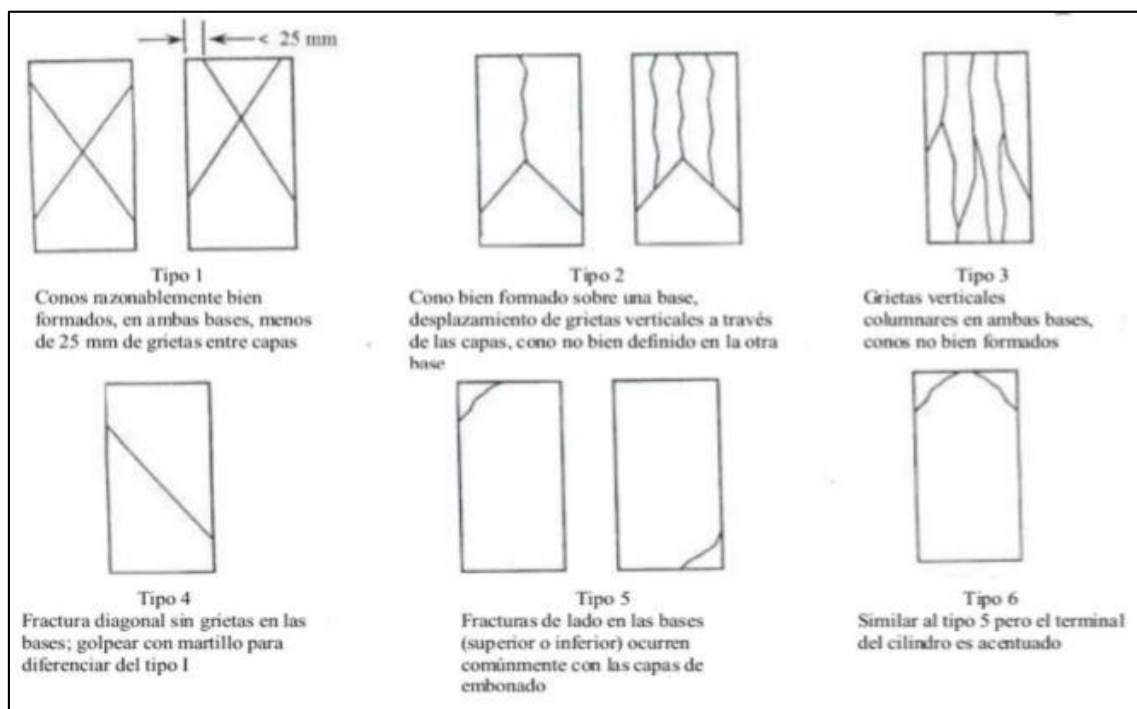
Tipos de fallas de probetas a compresión del concreto.
